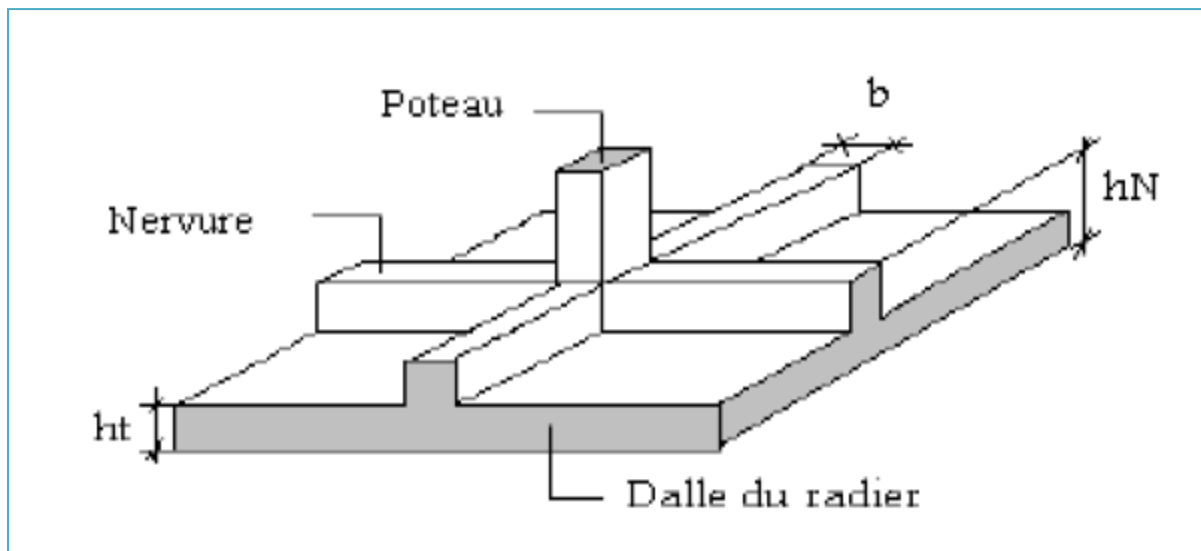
Disposition des nervures par rapport au radier et aux poteaux.
